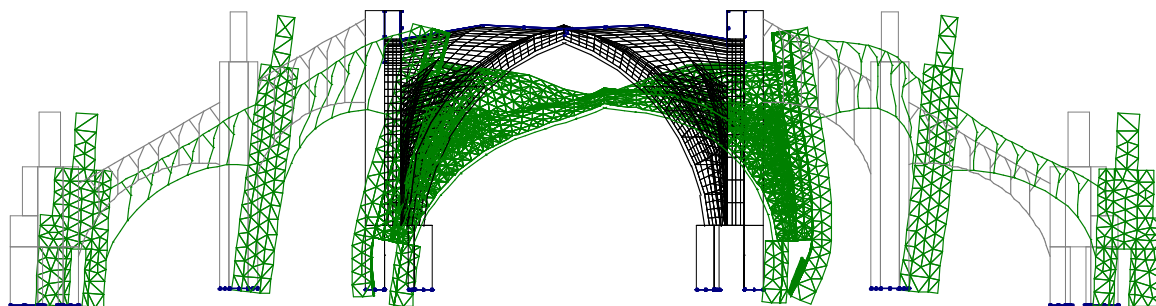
Konstrukce vysokého chóru a opěrný systém 12-28-42 s pevnými podporami, zatížení vlastní tíhou
